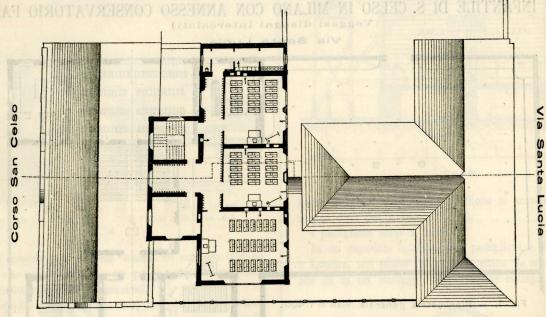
Pianta del piano superiore (Scala di 1:400).
